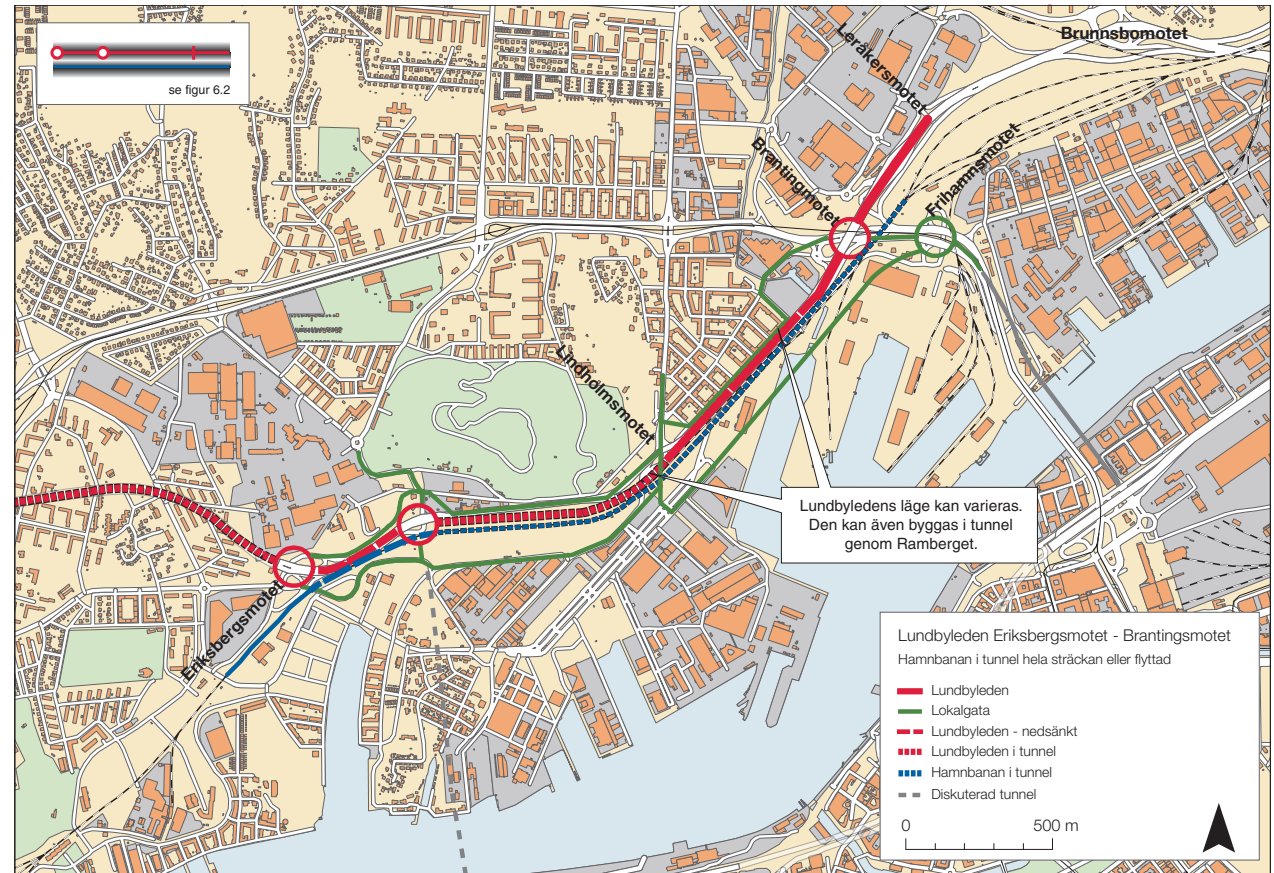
Målbild halvtunnel, alternativet betongtunnel/tråg: Hamnbanan och leden i betongtunnel förbi Ramberget.
